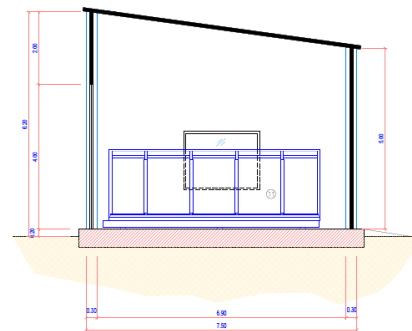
Pinta e sezione dei nuovi locali Disidratazione e Cassoni
